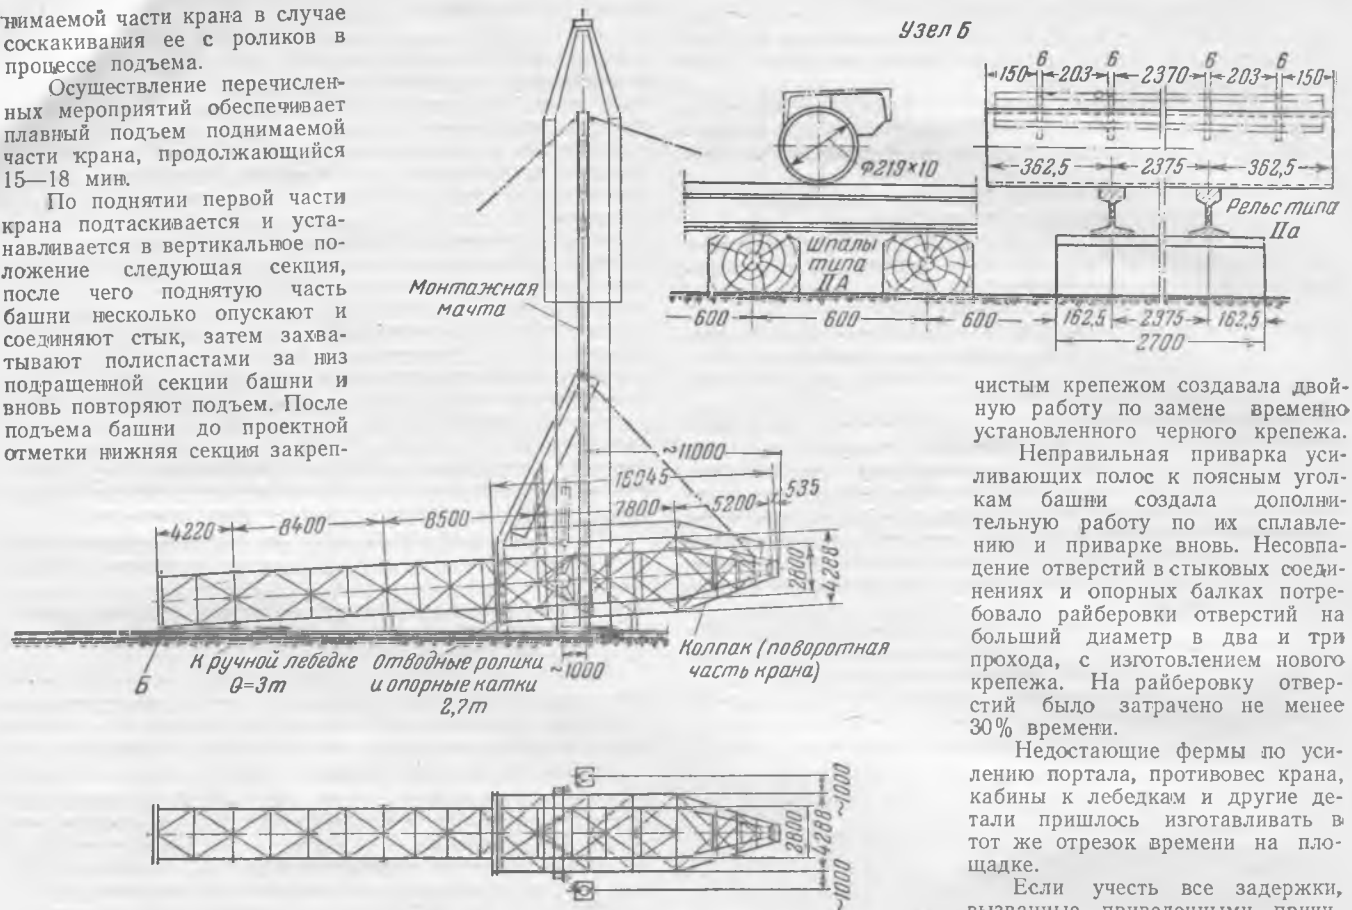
Такелажная схема монтажа крана БК-403 двумя монтажными мачтами. Вид вдоль оси симметрии кранового пути.
